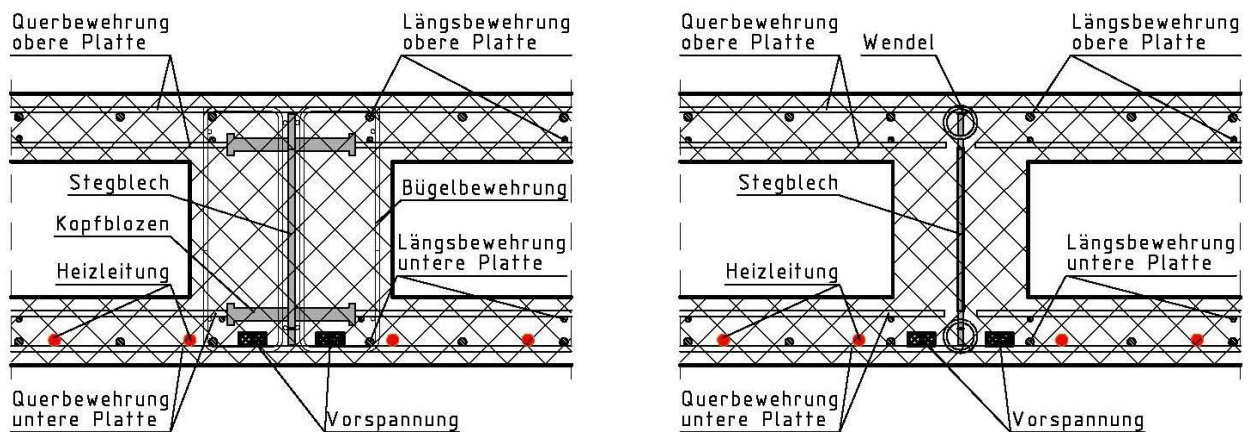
Vergleich der Bewehrungsführung bei randnahen Kopfbolzen und bei Betondübel
